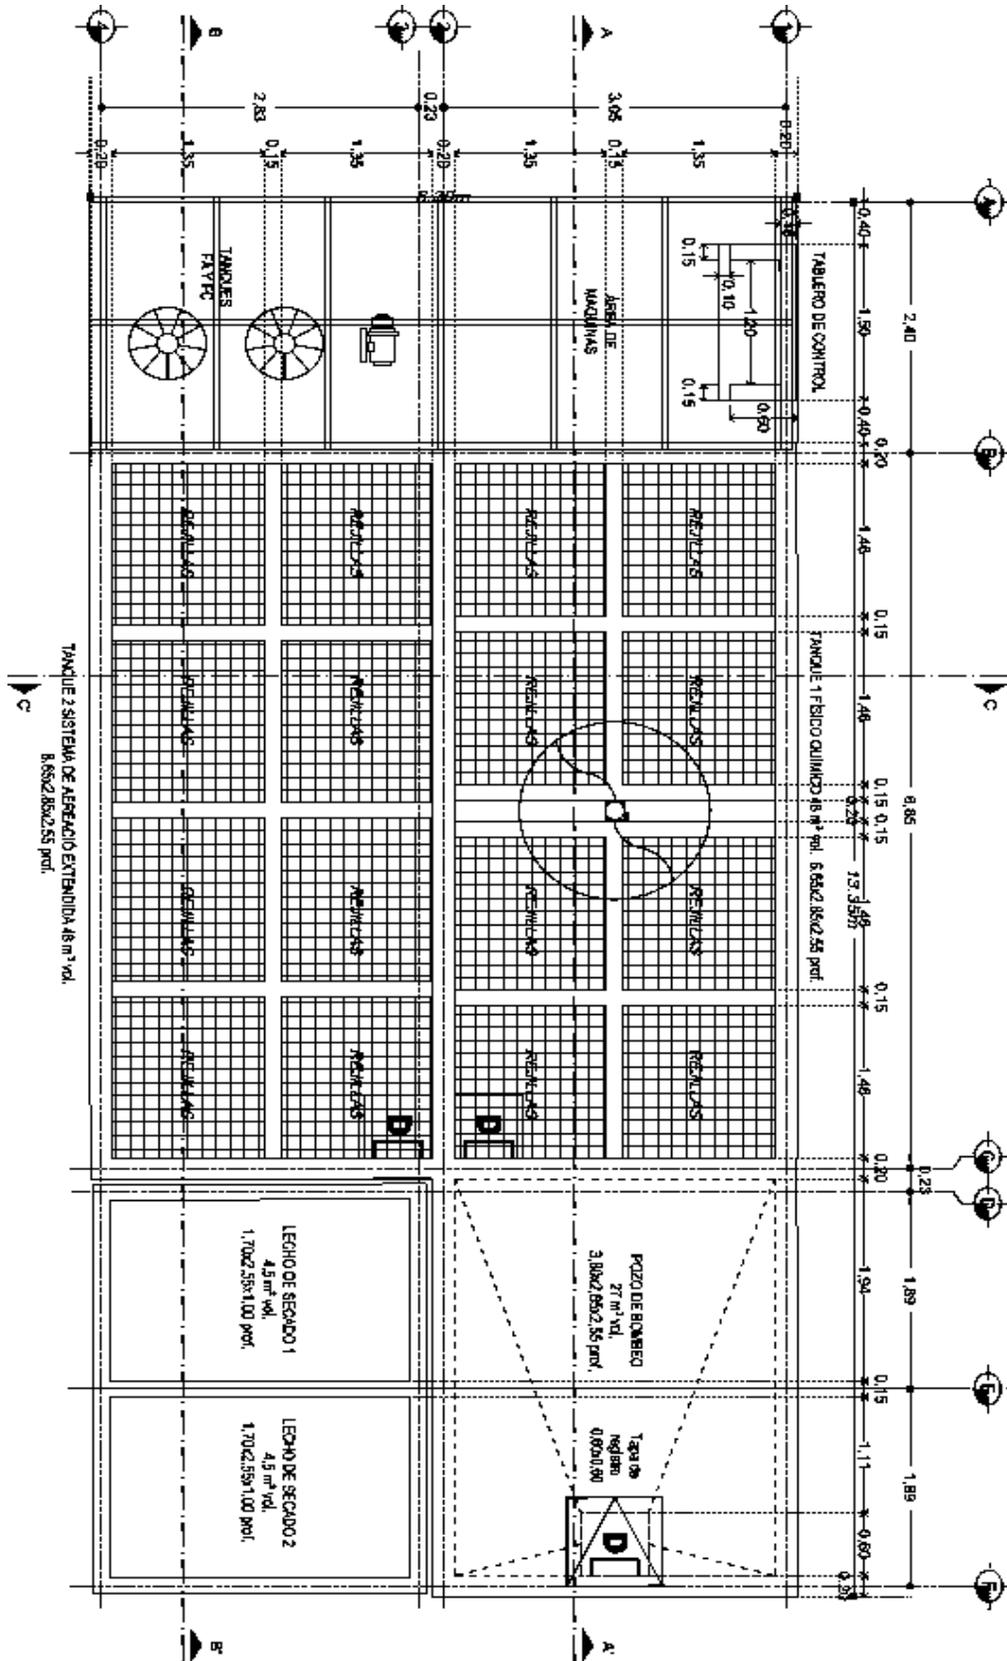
A.- Planta de Conjunto de Planta Tratadora de Aguas Residuales.
